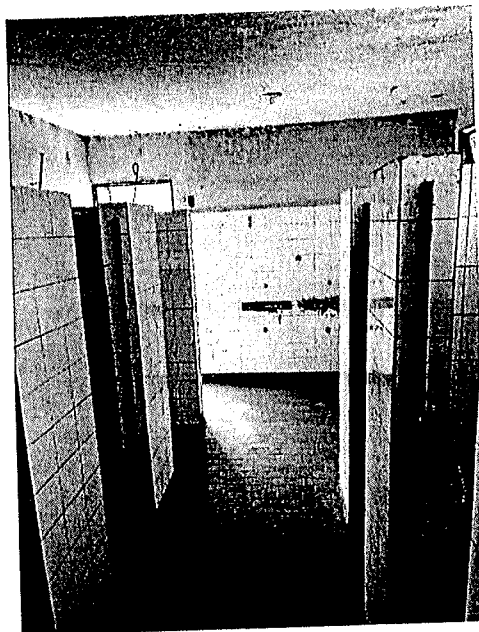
O interior do bloco sanitário apresenta paredes internas em alvenaria, com revestimento cerâmico até a altura dos boxes. O piso é revestido com cerâmica tipo vermelha. A laje de cobertura é maciça, com pintura aplicada, sem forro instalado. O bloco possui compartimentação interna em alvenaria para formação dos boxes e janela superior contínua para ventilação.
